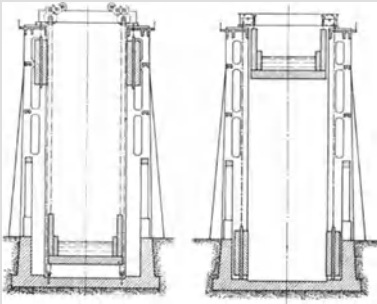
a u. b. Hebewerk Demag mit Gegengewichten.
